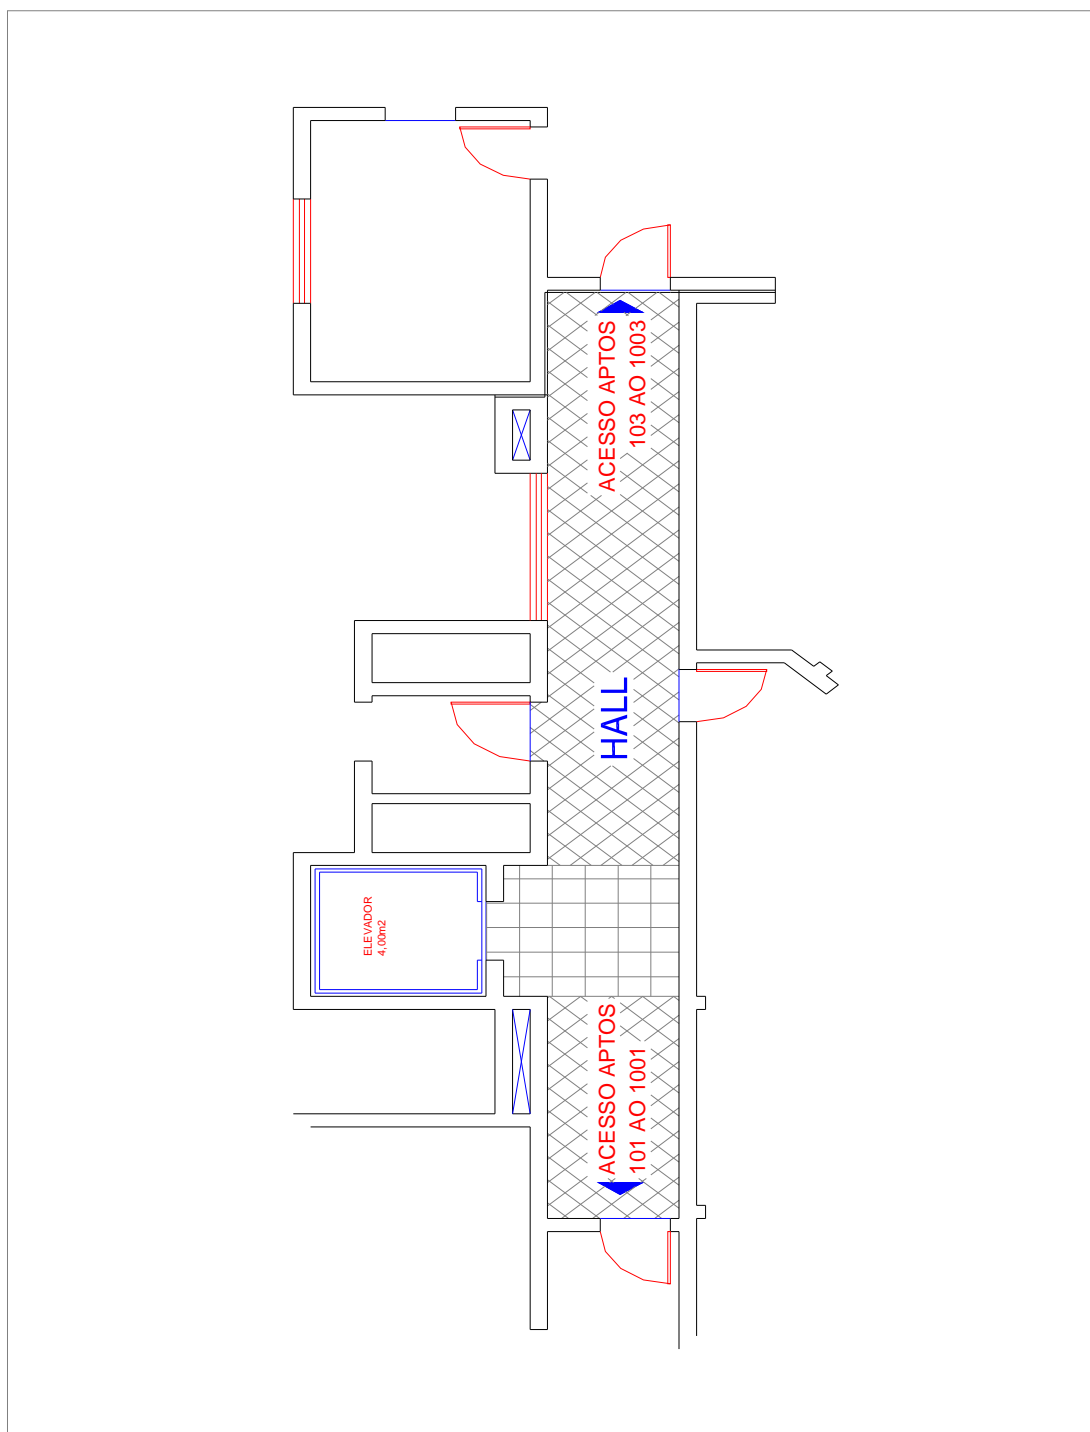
Planta baixa da área de circulação dos pavimentos 1º ao 10º.
